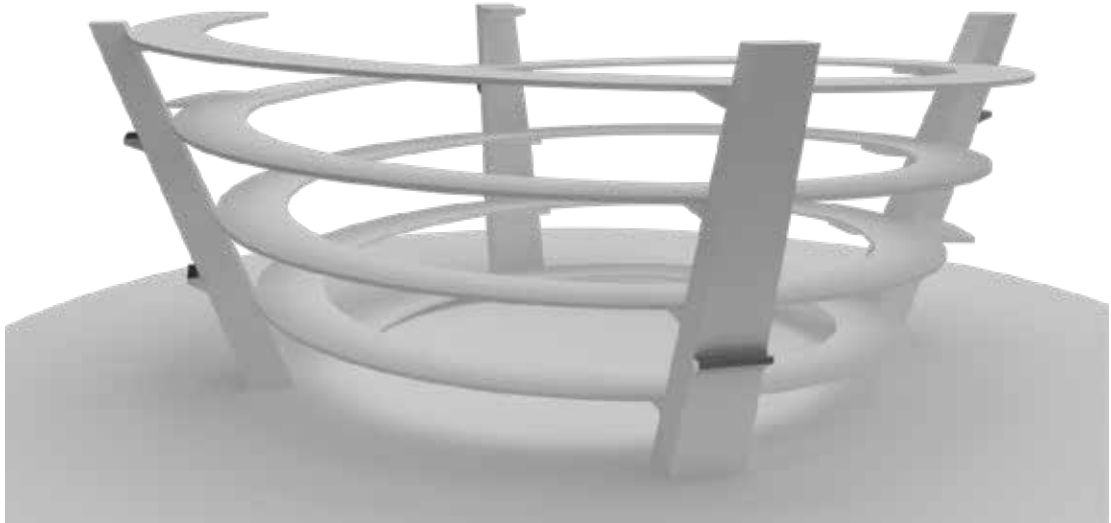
Columna Inclinada. Estructura de rampa helicoidal. Fuente: Autor (2021)
